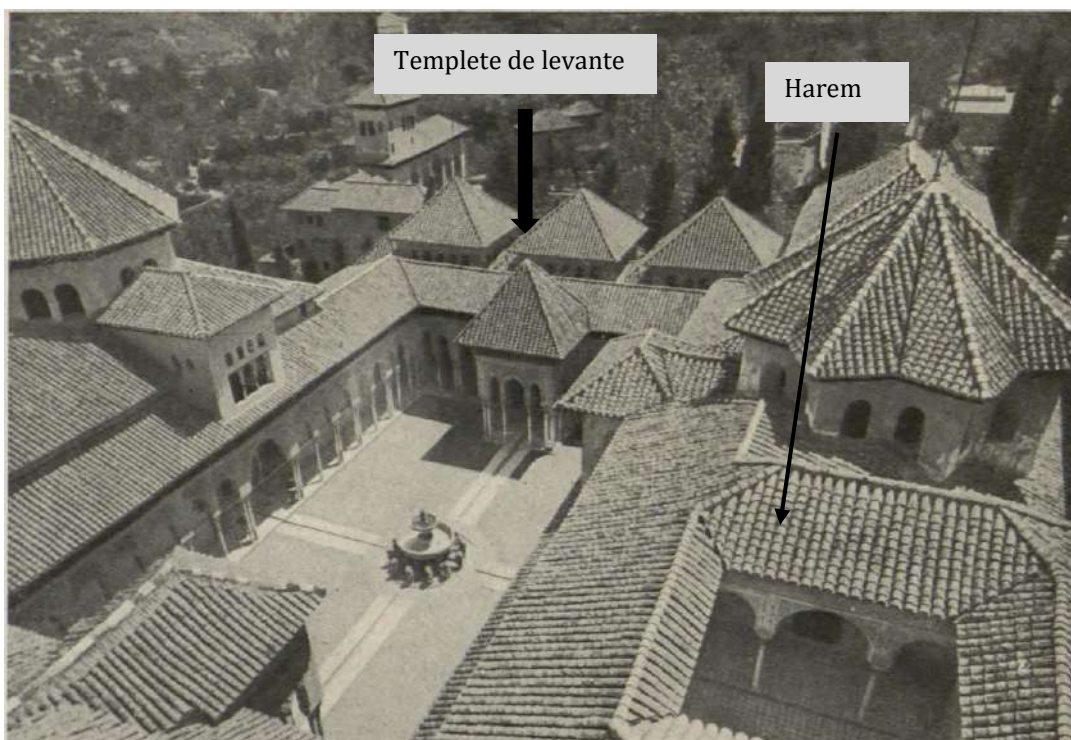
Imagen del Patio de los Leones donde podemos observar, entre otros elementos, el templete de levante tras la reconstrucción de sus cubiertas efectuado por Torres Balbás. (Revista Nacional de Arquitectura, 1941).
